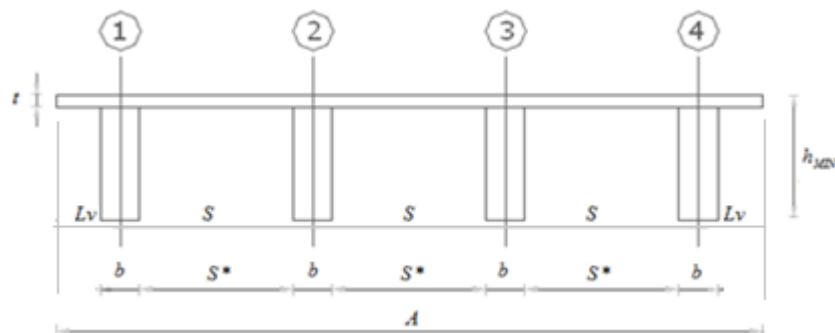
Nomenclatura en la sección transversal del puente de vigas de hormigón pretensado y tablero de hormigón armado (alternativa “B”)
